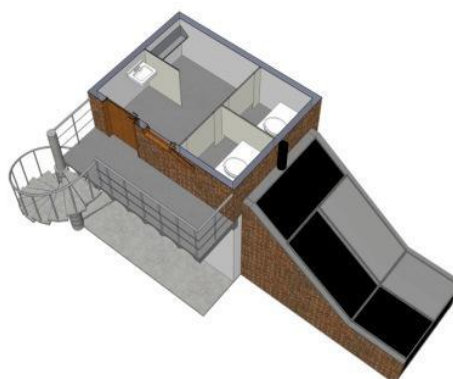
Corte horizontal - secção do segundo pavimento (Autor: Lucas Sabino Dias).
